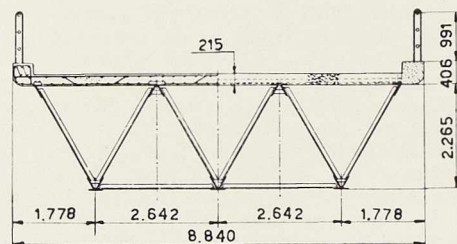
Projet de pont à 6 poutres en V d'une portée de 36,6 mètres.
